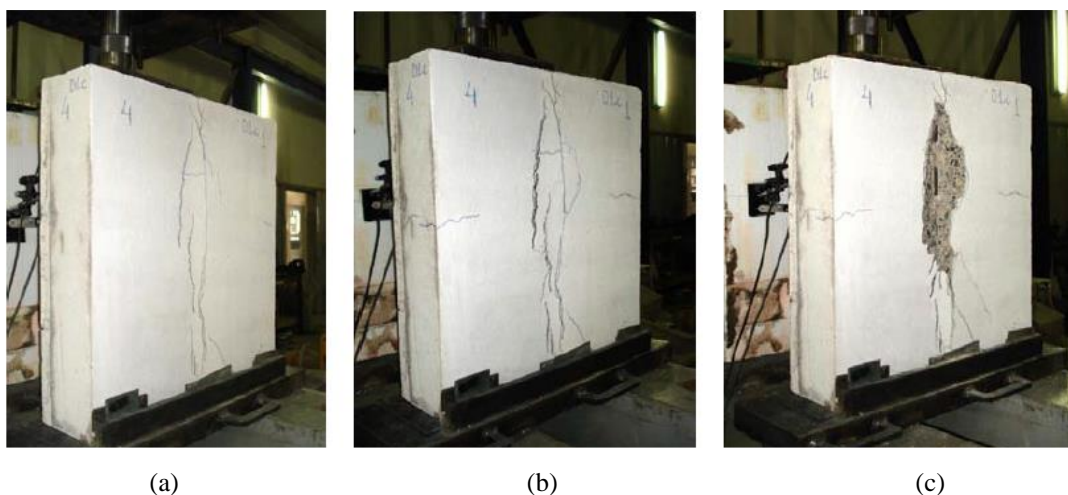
Padrão de fissuração com o avanço do carregamento no modelo D1c: (a) formação de fissuras longitudinais, (b) início do desprendimento da região de concreto acima dos conectores, (c) *pry-out* consolidado
